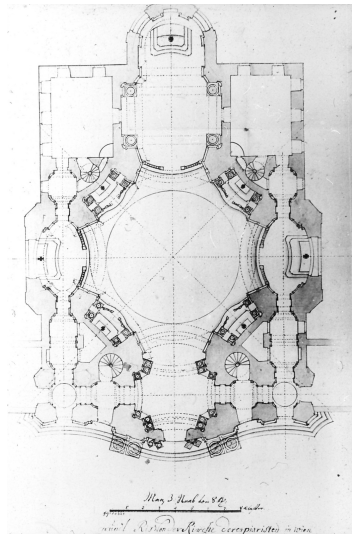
und 125: Grundrisse Piaristenkirche Wien und St. Laurenz in Gabel
